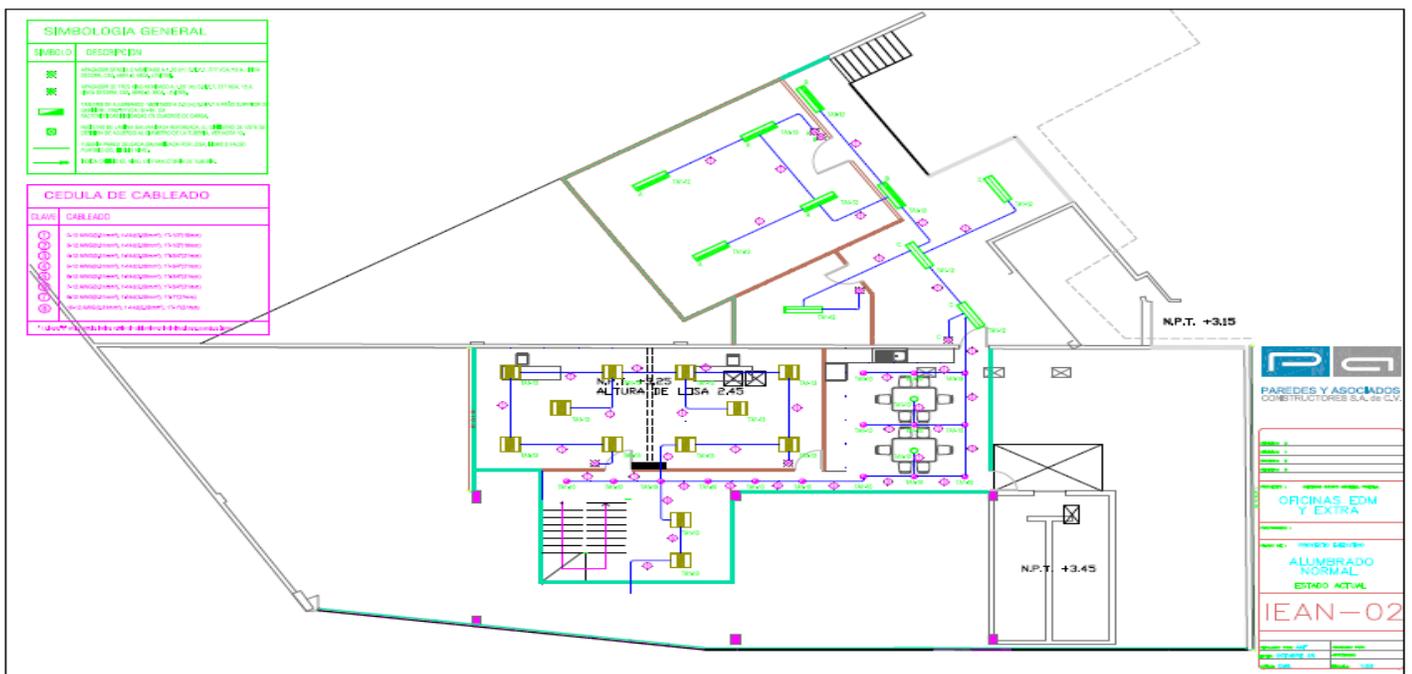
PLANO DE ALUMBRADO NORMAL EN PLANTA ALTA.
